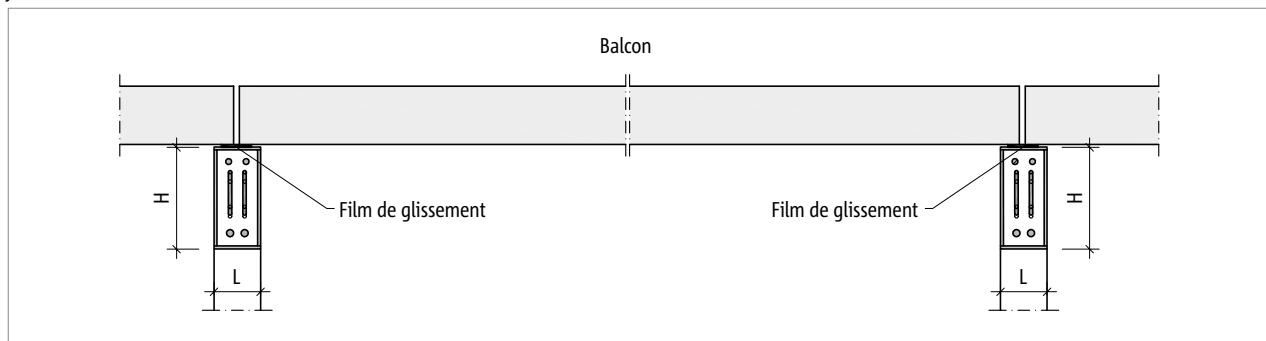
Schöck Isokorb® T Type B : Coupe ; Résistance à la fatigue grâce au film de glissement entre les dalles de balcon et les poutres en porte-à-faux
